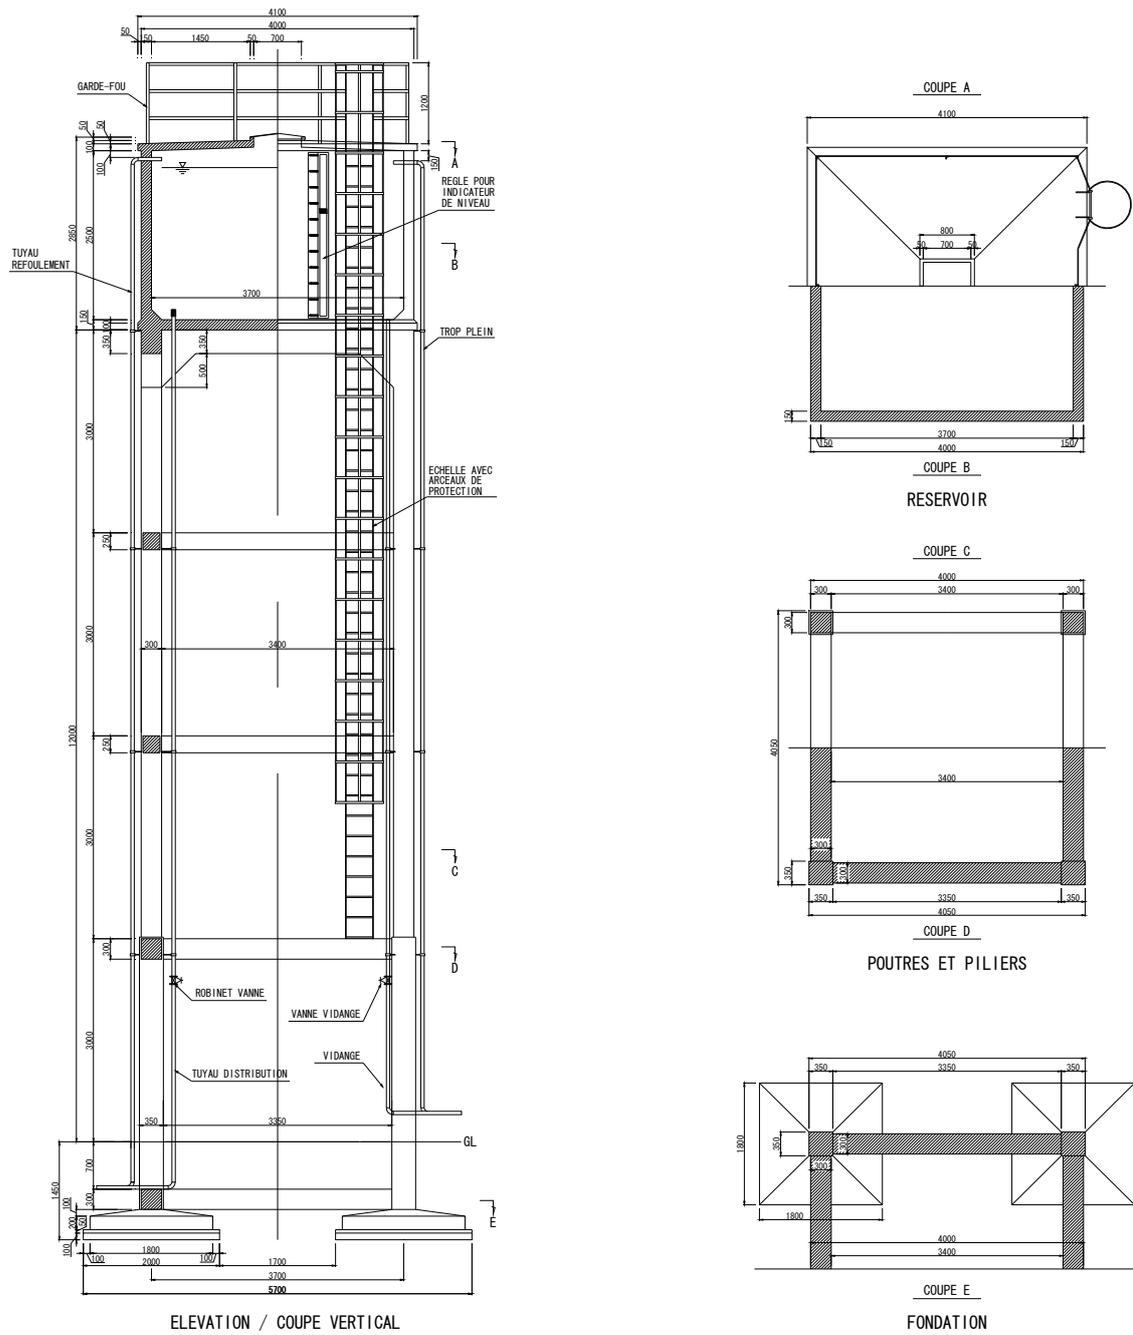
Plan structural de réservoir surélevé 30 m³ H=12 m
